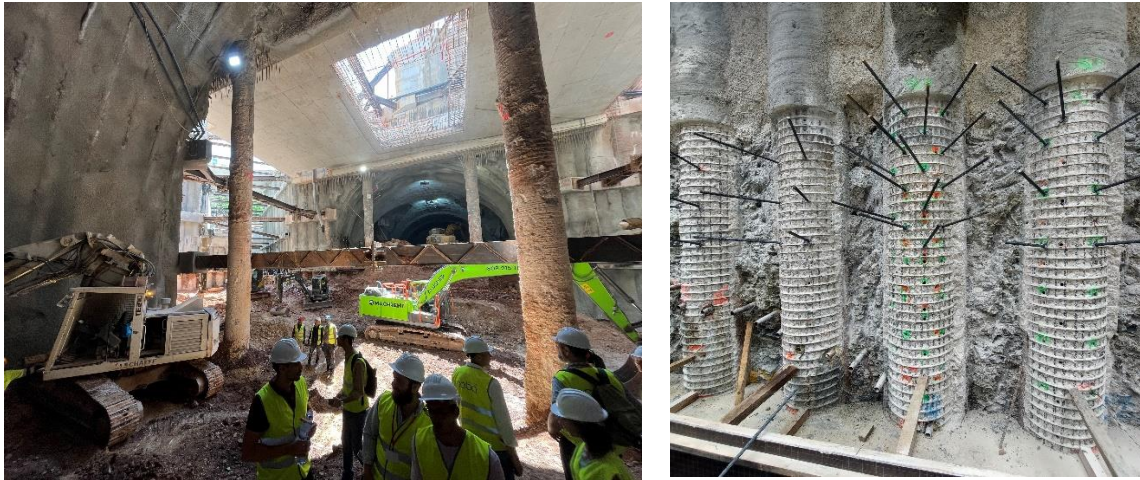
Laje de travamento e execução dos ferrolhos das vigas-parede à cortina de estacas.
